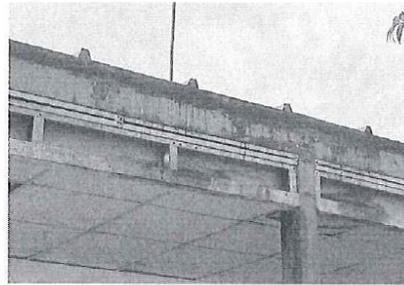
Se observa vigas y columnas metálicas en la parte superior de farmacia de emergencia en mal estado, presentando óxido.
